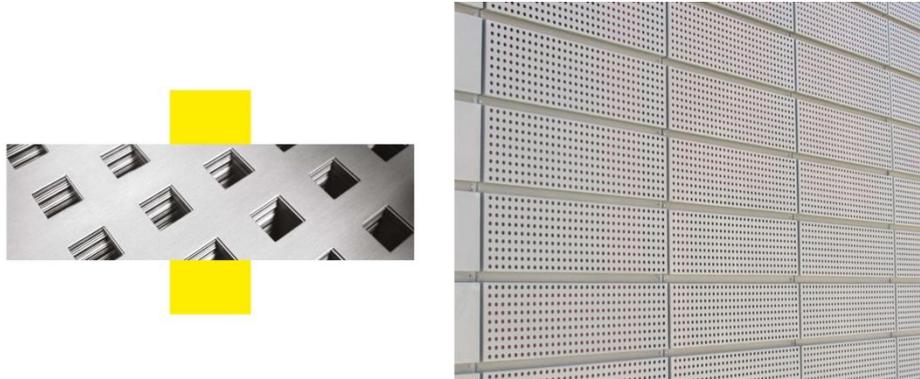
Detalle chapa perforada y aplicación arquitectónica.
